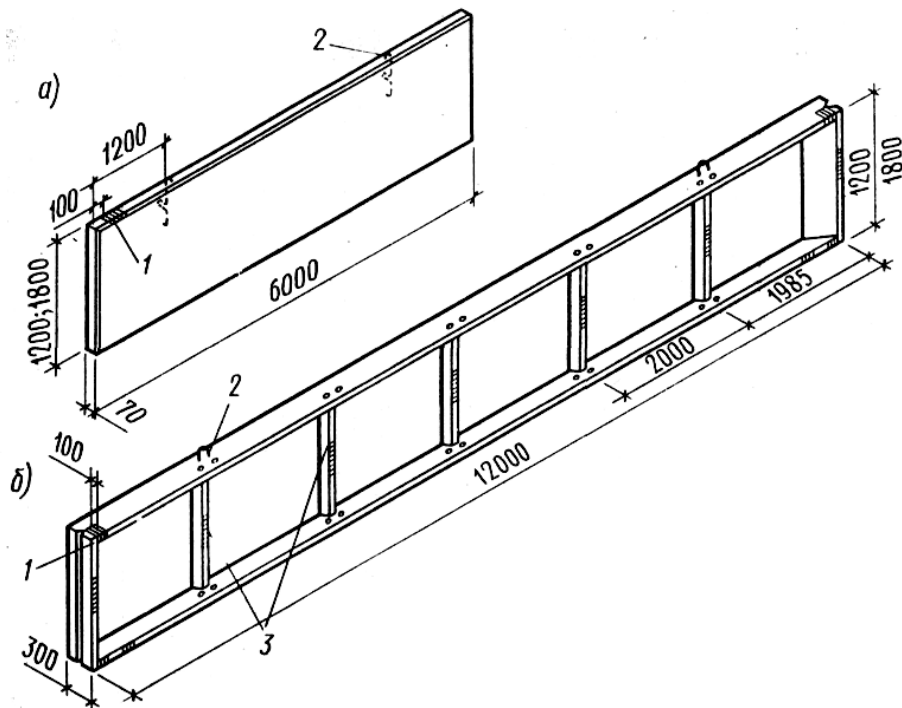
Железобетонная панель неотапливаемого здания:
